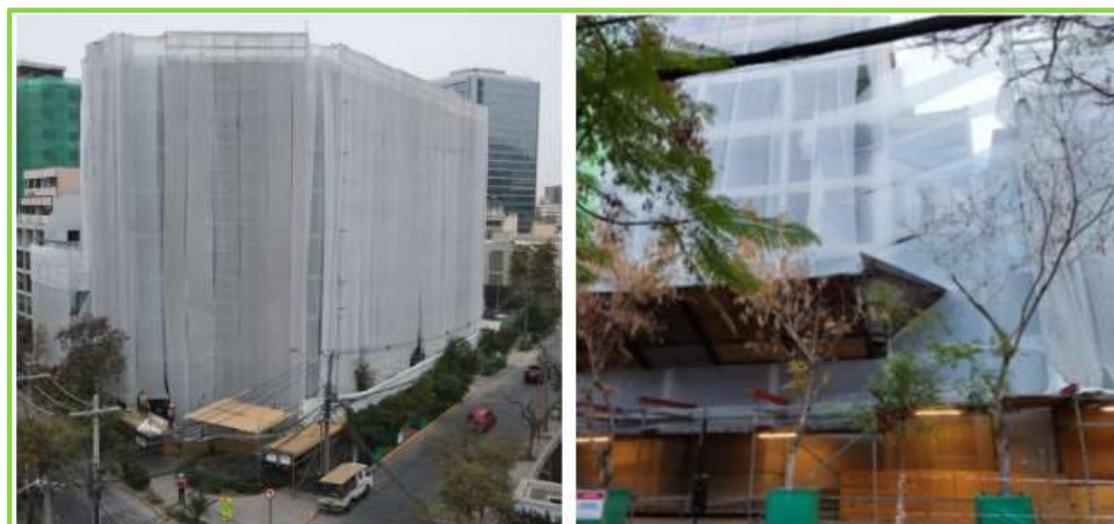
Protección de fachada con malla raschel e instalación de andamios, Almirante Pastene.
